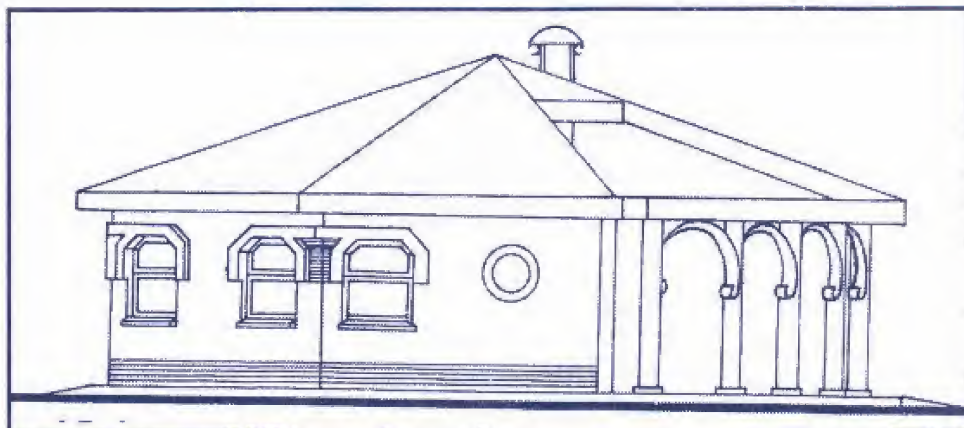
Фасад жилої будівлі з внутрішнім двориком
